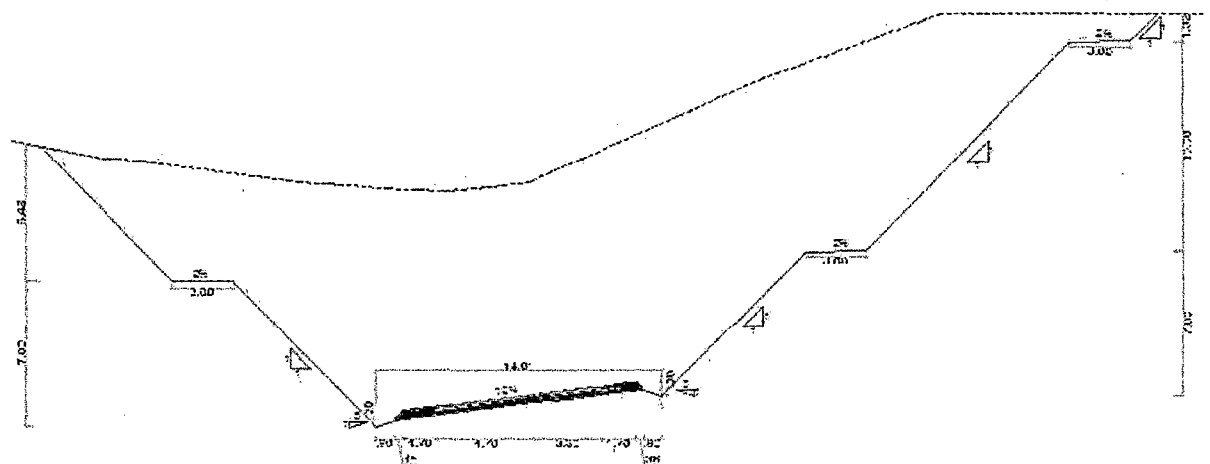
Sección transversal (en corte) en curva con banquetas en ambos lados - Fuente. Elaboración Propia
